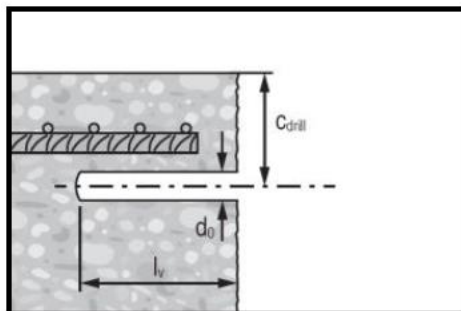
Схема подготовки отверстия для обеспечения нахлеста
